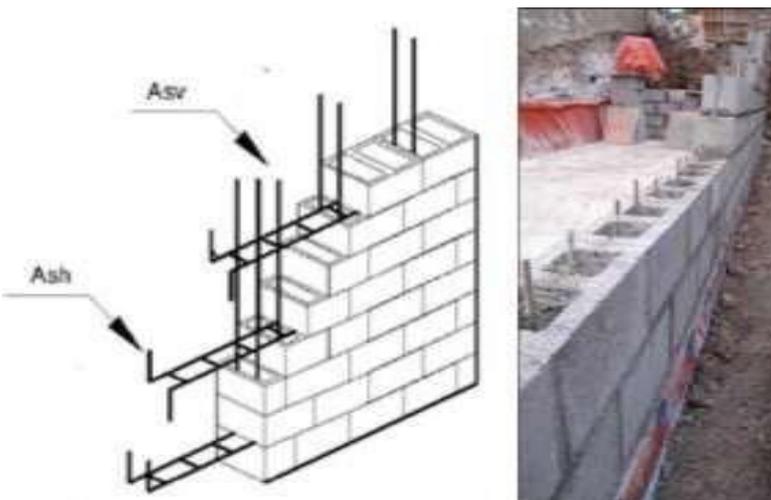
Tipo de sistema estructural: Mampostería reforzada (RM).
